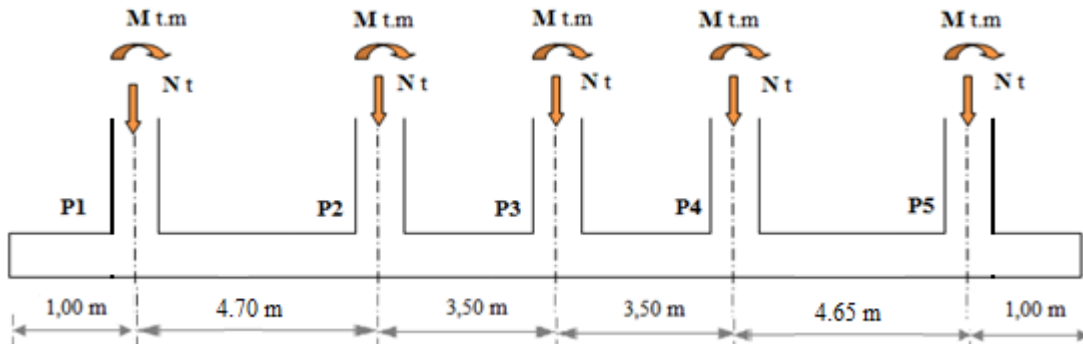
La distribution des sollicitations appliquées sur les semelles sous poteaux
